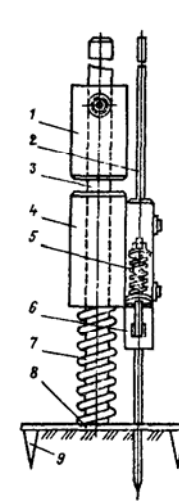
Приспособление для забивки заземлителей, опираемое на землю:
